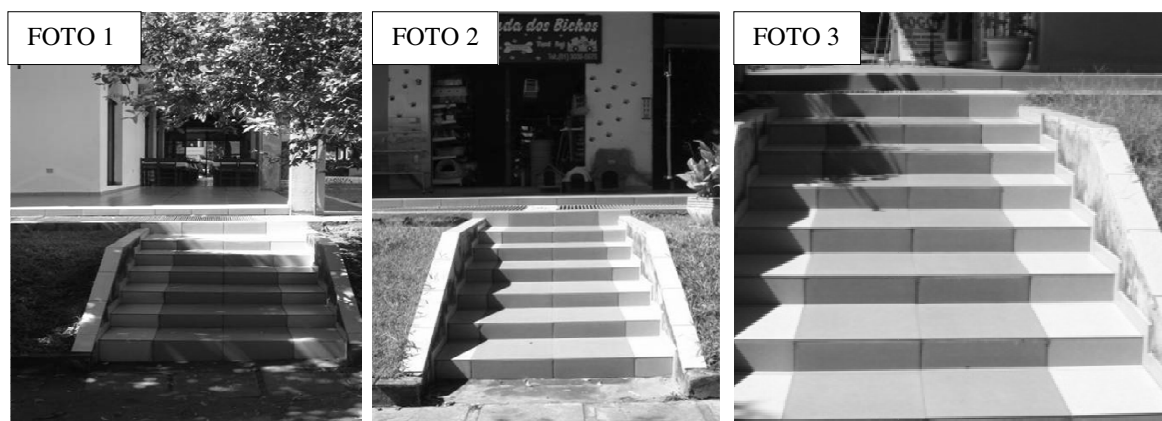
Foto 1, Escada 407NBE3; Foto 2, Escada 407NBE4; Foto 3, Escada 407NBE5
